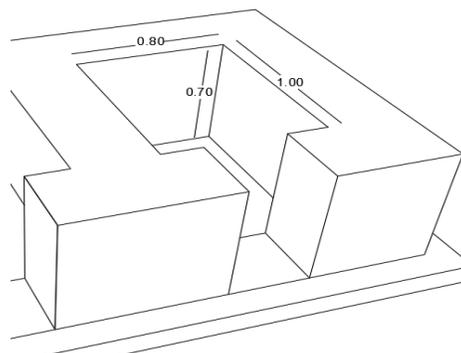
Dimensionamiento de cámaras para baño seco. Fuente: Elaboración propia.
